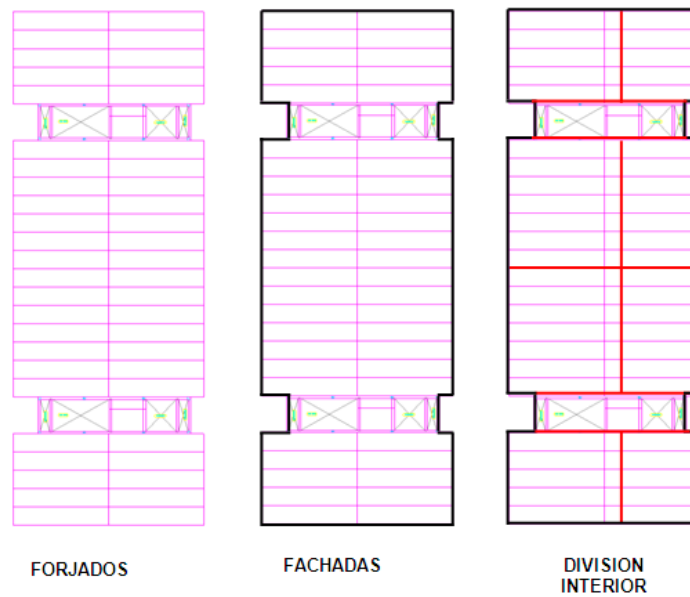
Ubicación de los distintos componentes en la planta del edificio.
